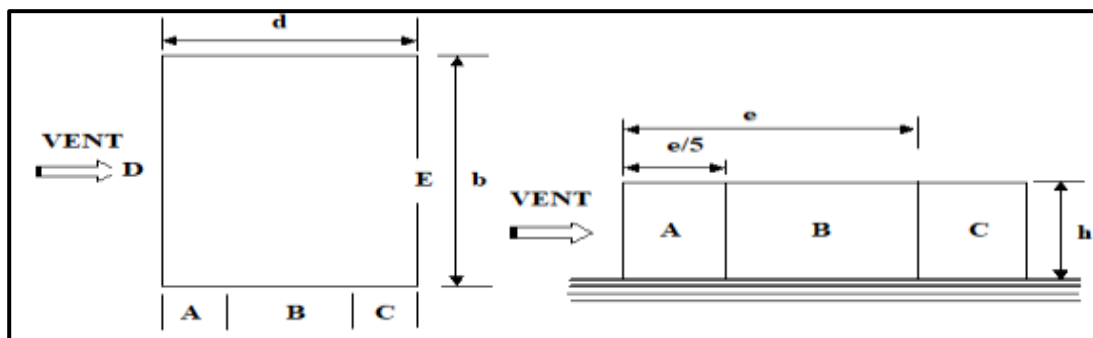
Vue en plan et vue en élévation, sens XY.
